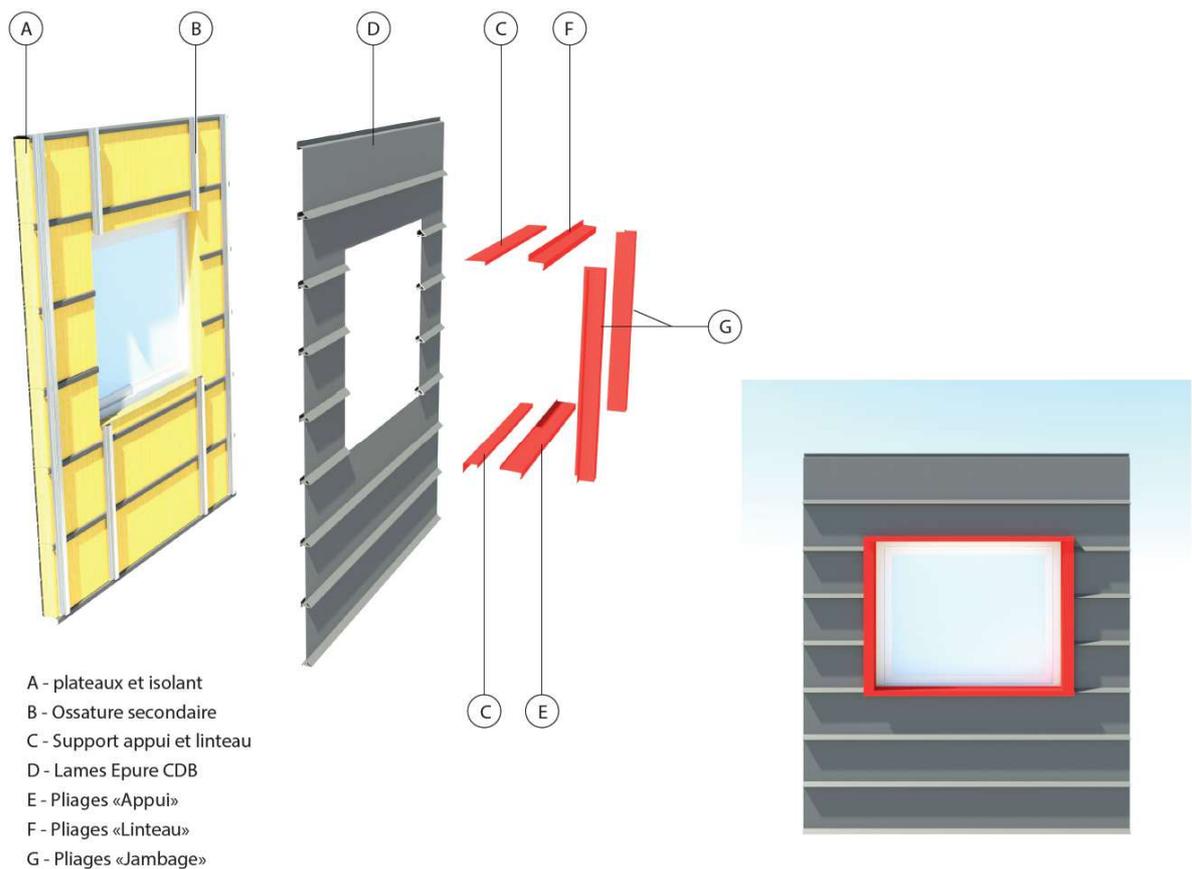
Habillage de baie en pose horizontale en bardage double peau sur plateaux
